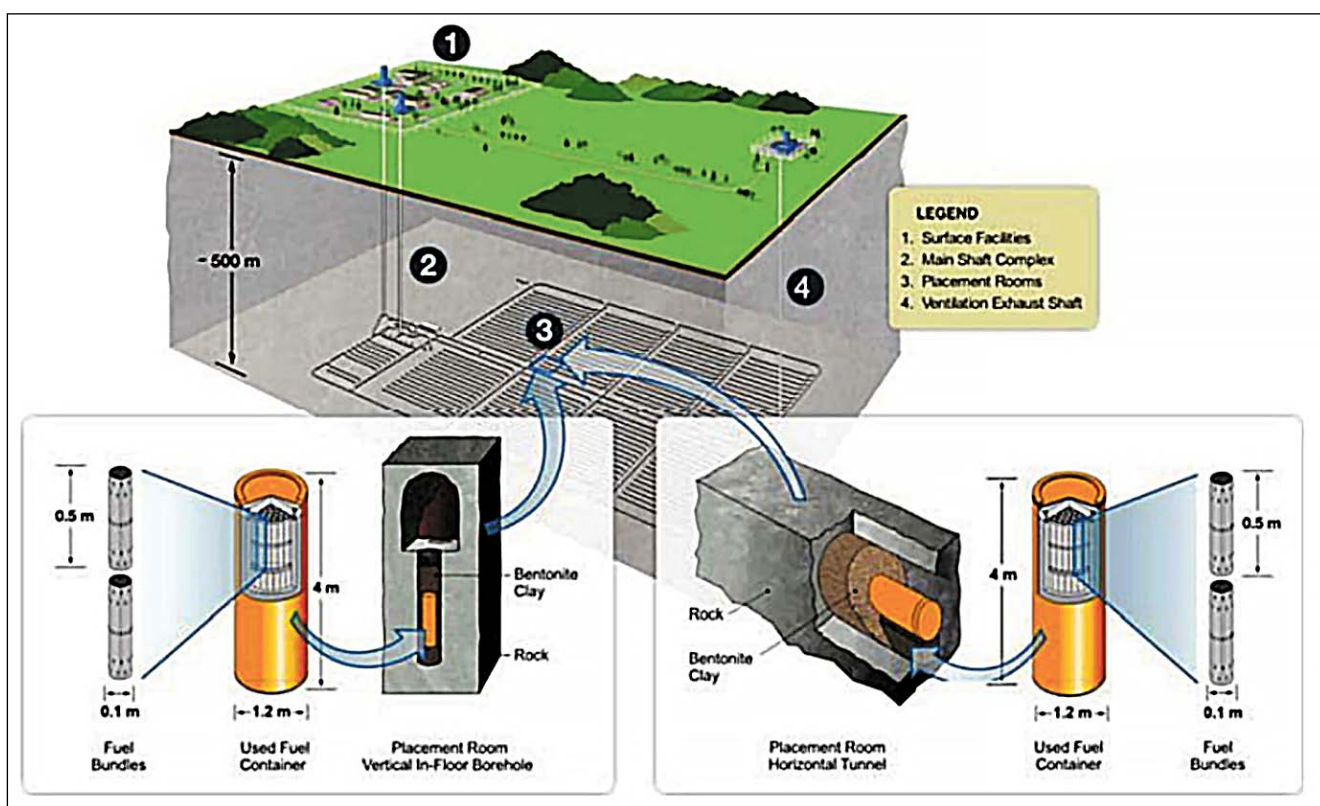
Совмещённые схемы наземных и подземных объектов хранилища в Канаде и его антирадиационных барьеров. file:///C:/Users/Owner/Downloads/cest_author_proof.pdf
